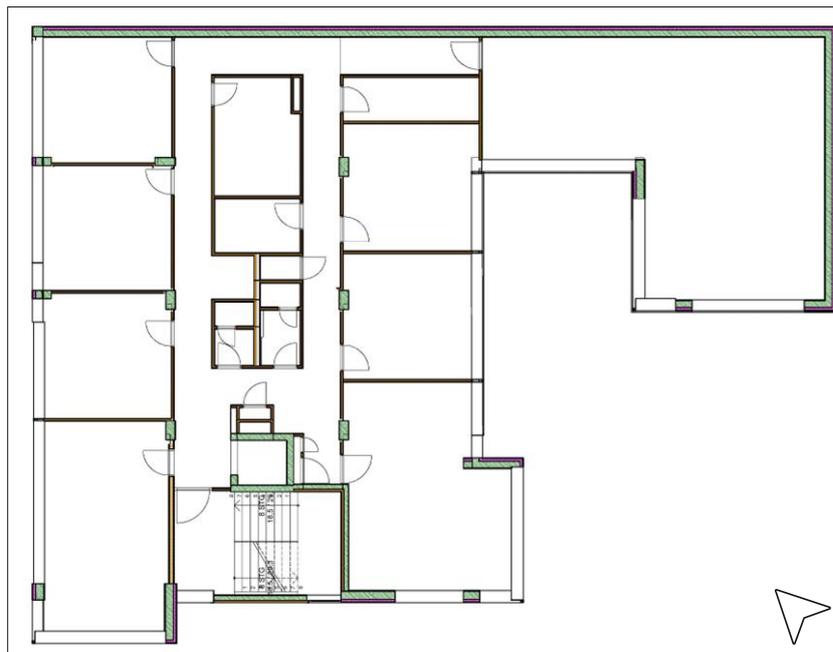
Fallbeispiel Grundriss Regelgeschoß
